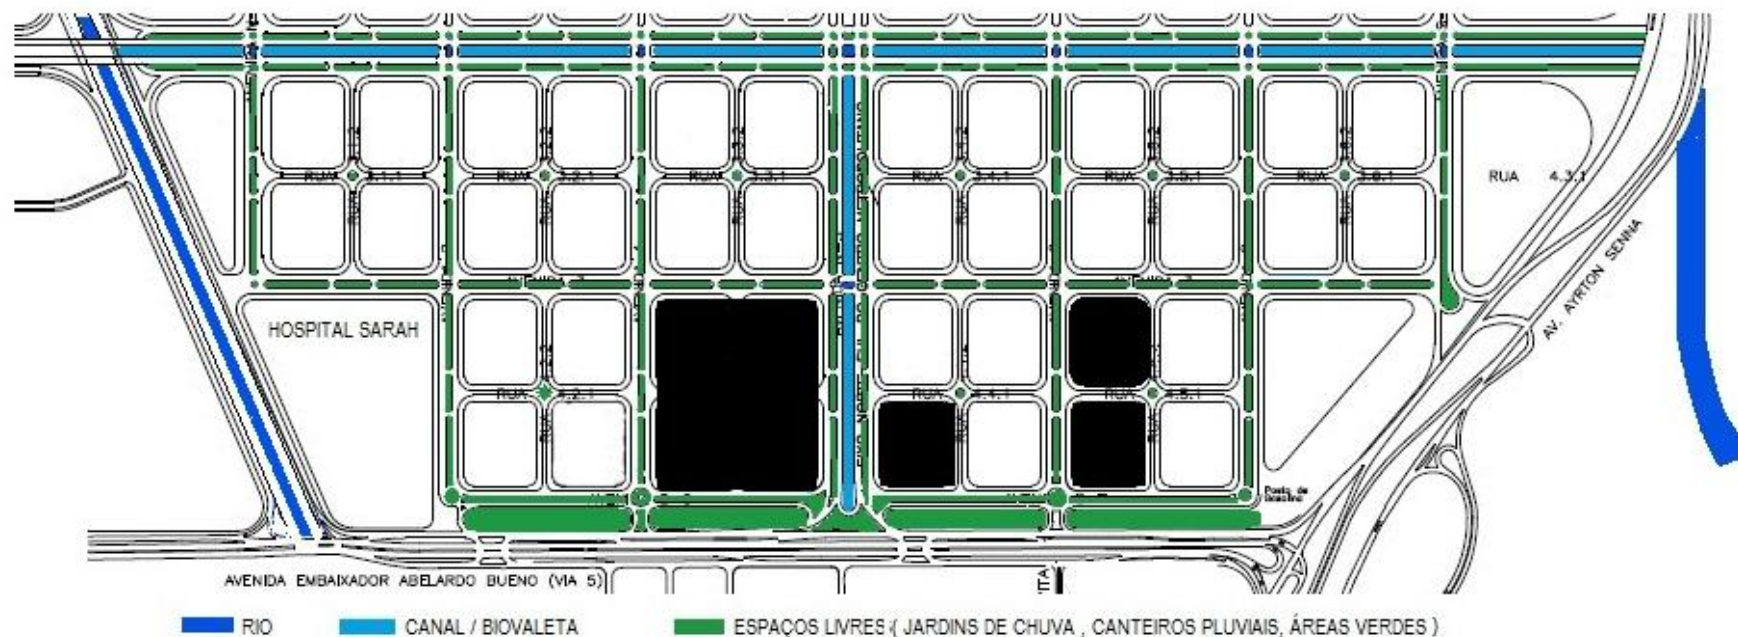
Planta Baixa: Área de atuação do Modelo Artificial
